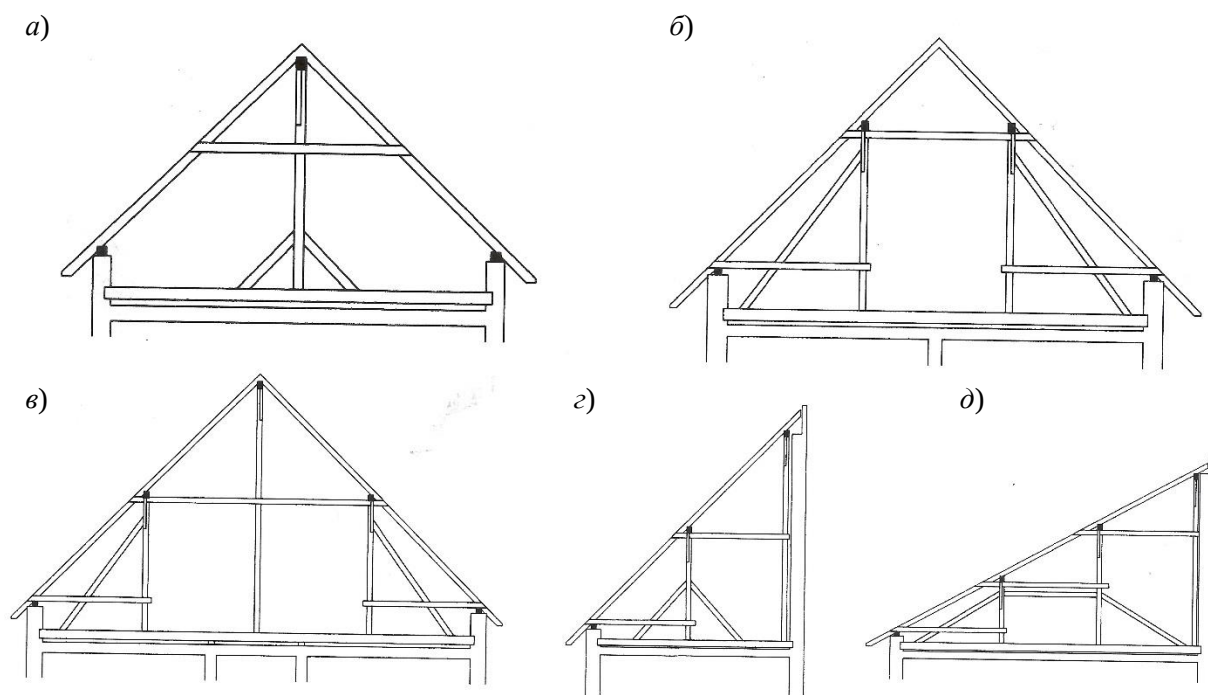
Обзор стропильных конструкций вертикальной фермы для различных пролетов и форм крыш: а) двухскатная крыша с пролетом от 6 до 8 м; б) двухскатная крыша с пролетом от 7 до 12 м; в) двухскатная крыша с пролетом от 11 до 16 м; г) односкатная крыша с пролетом от 6 до 8 м; д) односкатная крыша с пролетом от 7 до 12 м
